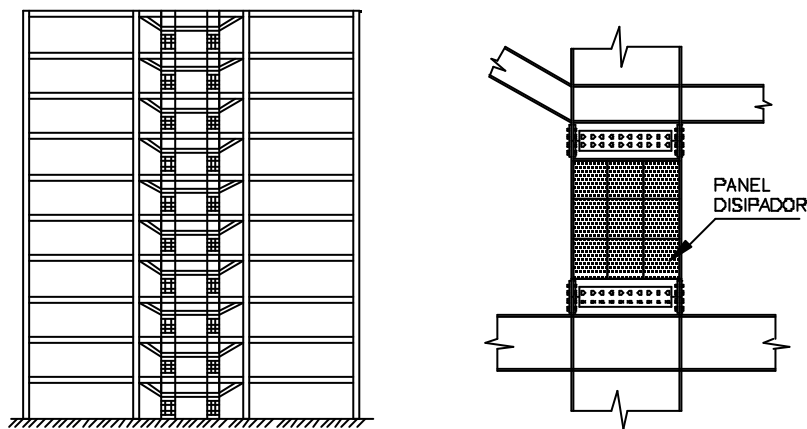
Disposición de paneles de cortante en una estructura metálica porticada (Nakashima 1995a)
